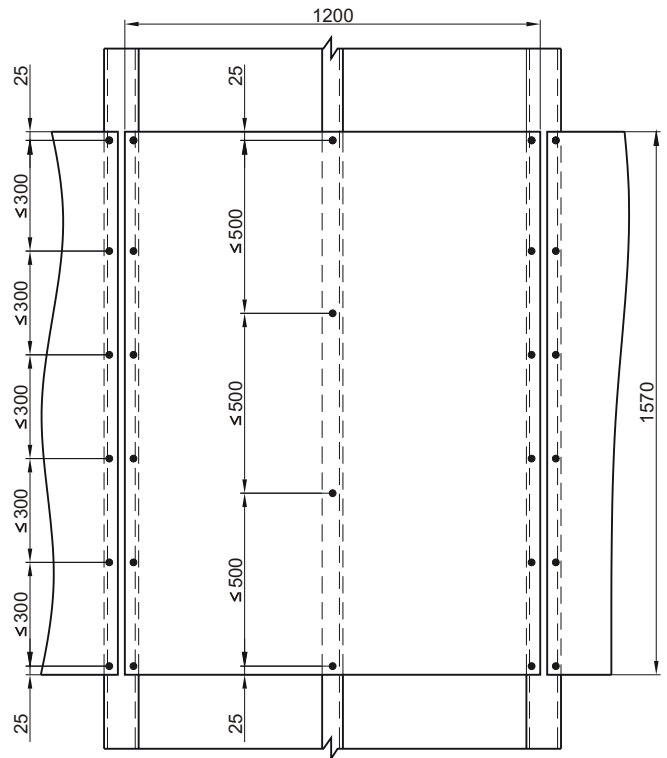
Схема крепления плоских панелей для здания высотой выше 12 этажей
